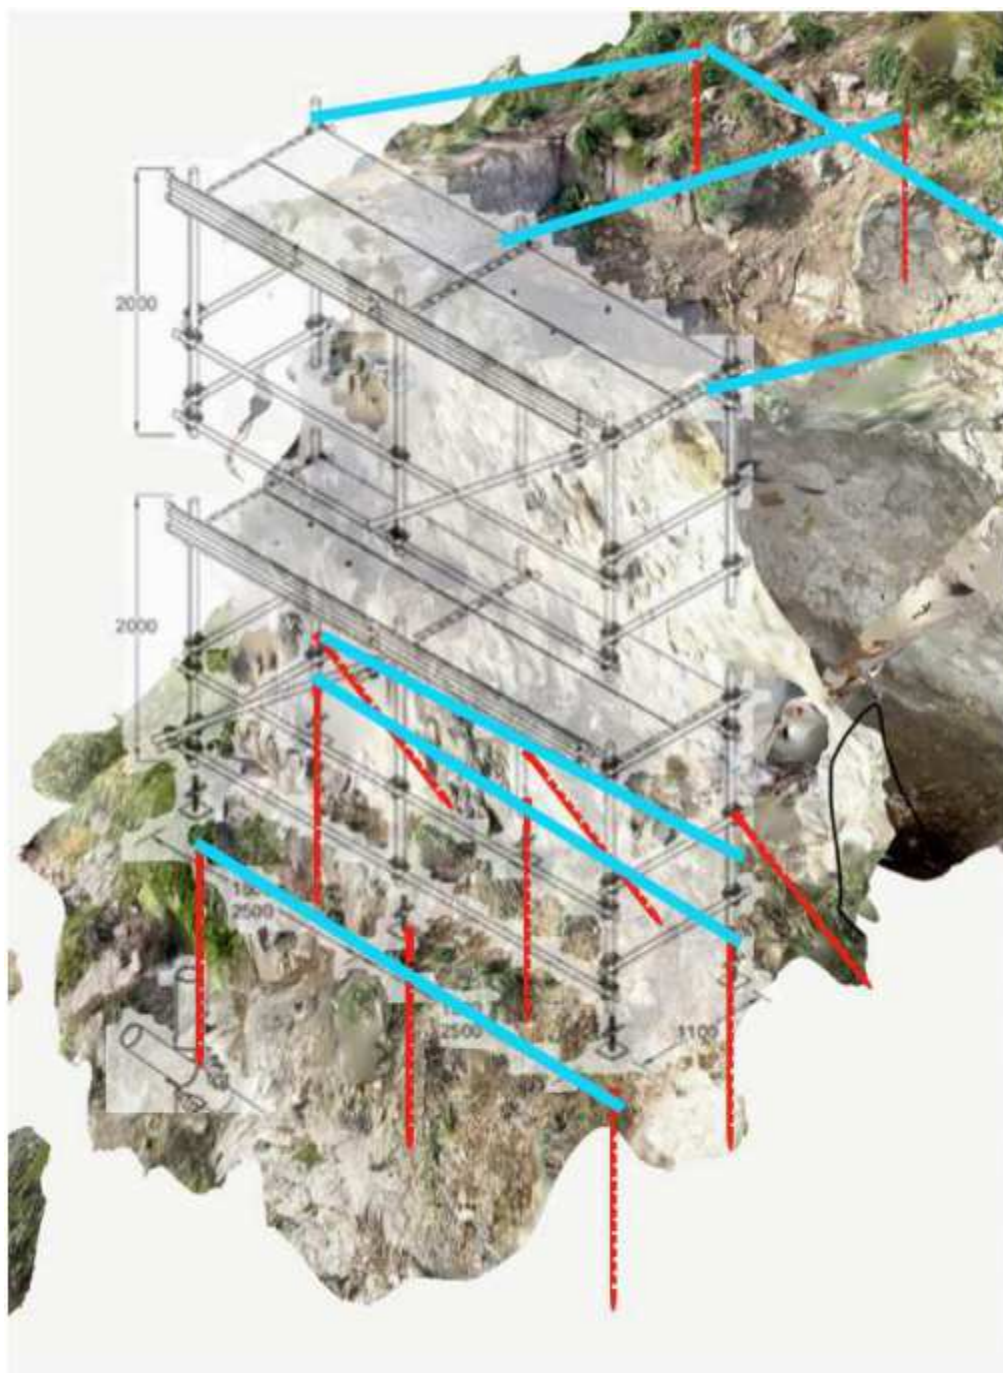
Rendering del ponteggio previsto lungo una sezione tipo
